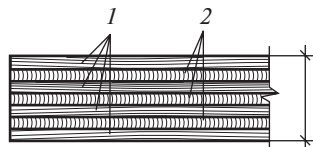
Строительная фанера (деталь сечения): 1, 2 — соответственно продольные и поперечные слои
